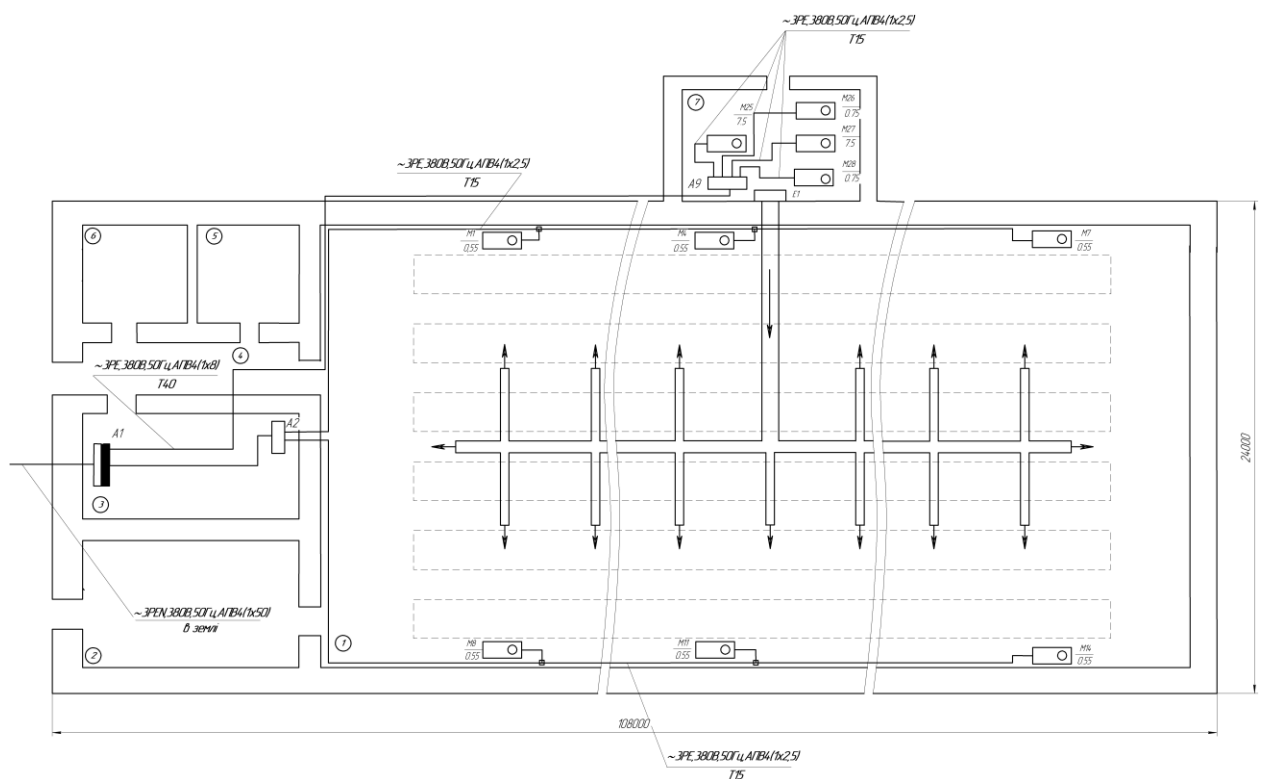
План пташника з розміщенням опалювально - вентиляційного обладнання
